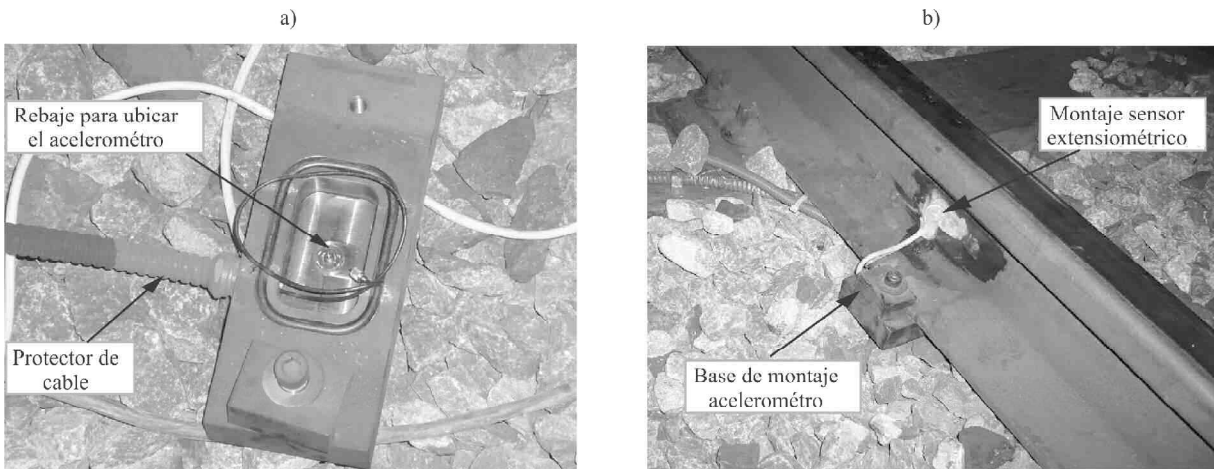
Montaje experimental a) del acelerómetro en el interior del utillaje y b) del sensor extensométrico
